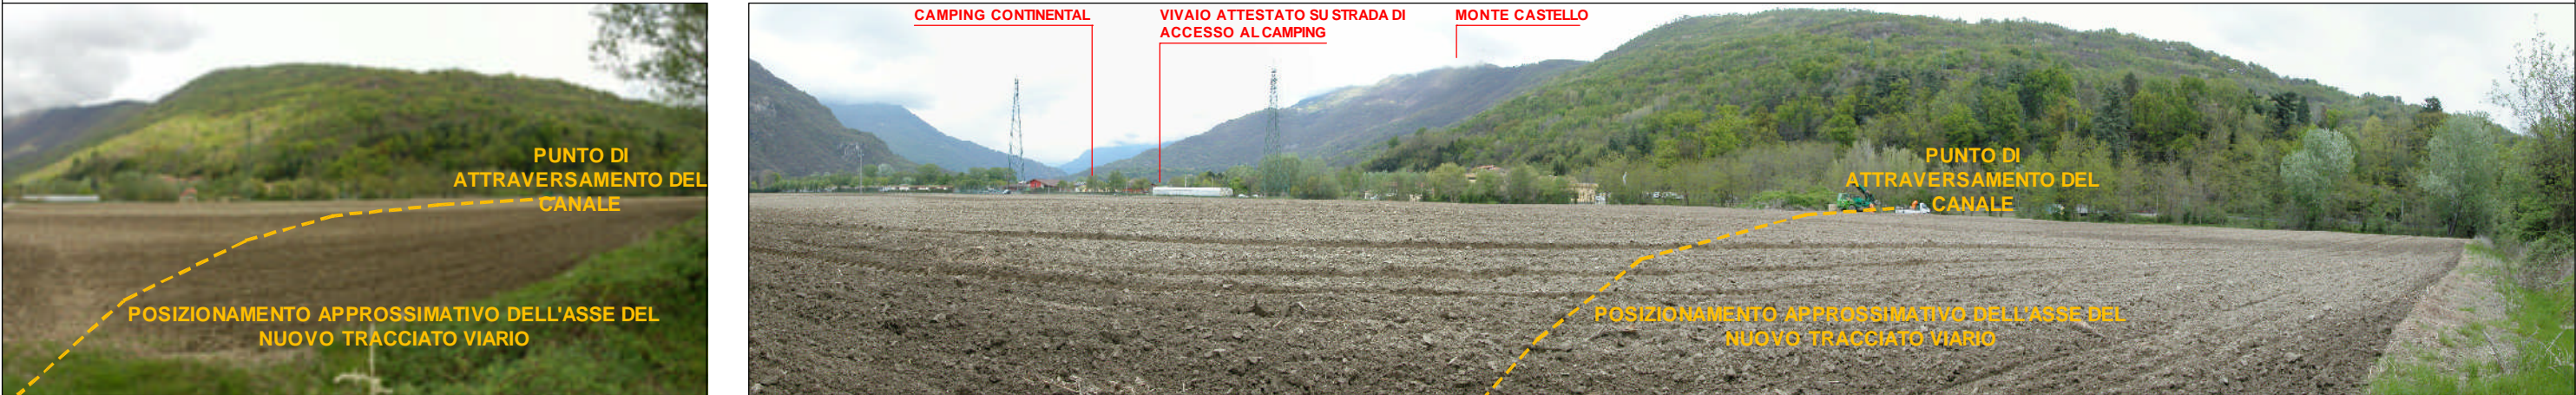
VISTE VERSO EST DALLA STRADA INTERPODERALE CHE CONSENTE L'ACCESSO AL CAMPING CONTINENTAL DALLA S.S. 34: SULLO SFONDO IL PUNTO DI ATTRAVERSAMENTO DEL CANALE
